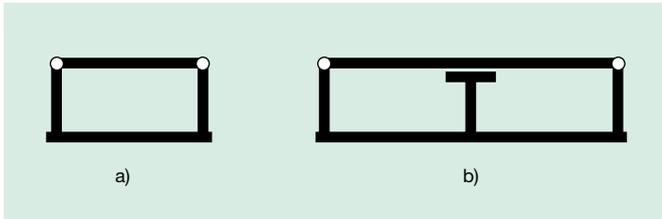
Fermenterabschluss mit Stahlbetonkreisplatte
